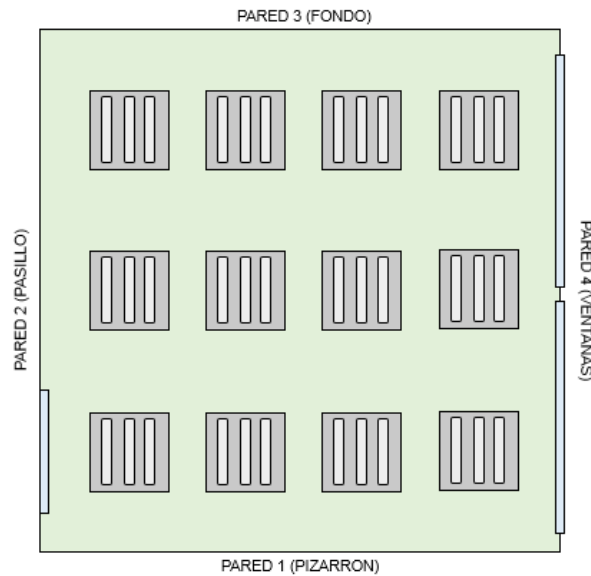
Distribución Edificio Ñ, sector B. Fuente: Elaboración propia
